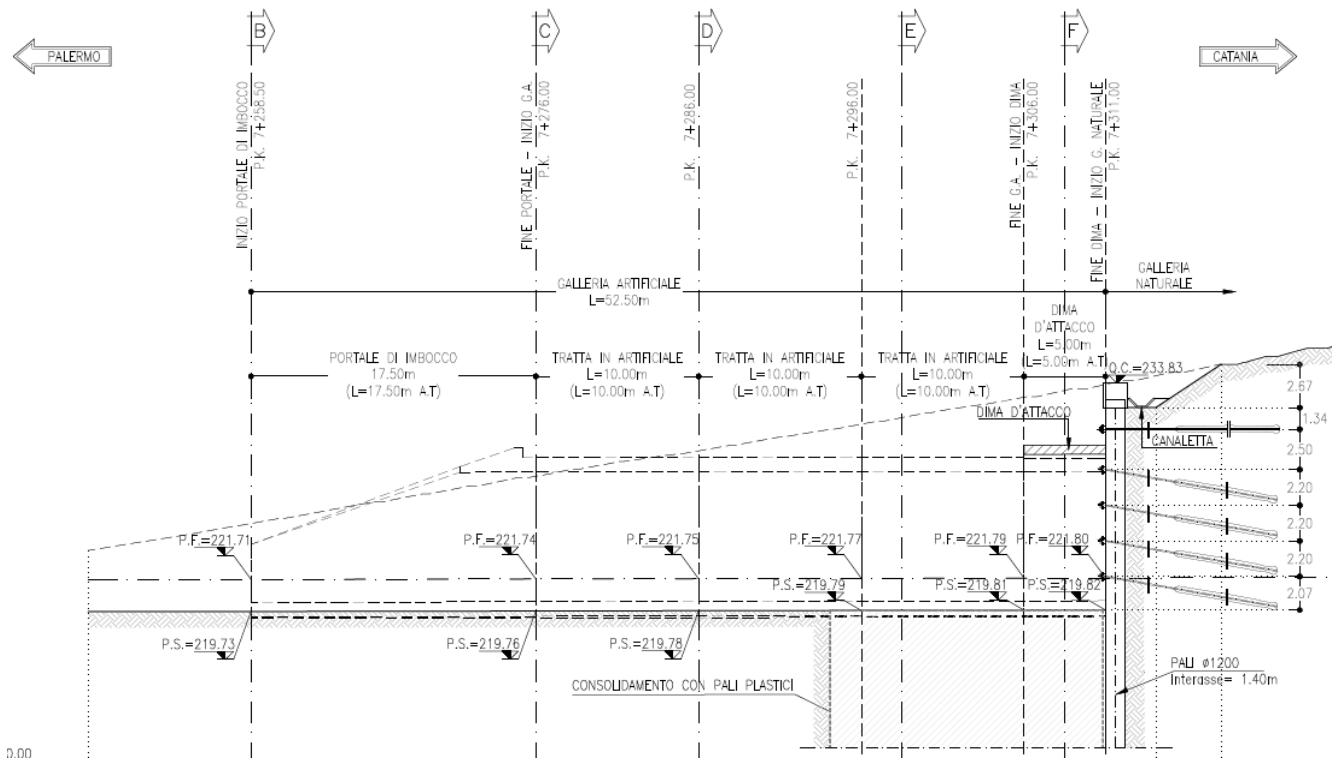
Profilo imbocco lato Palermo – fase provvisoria
